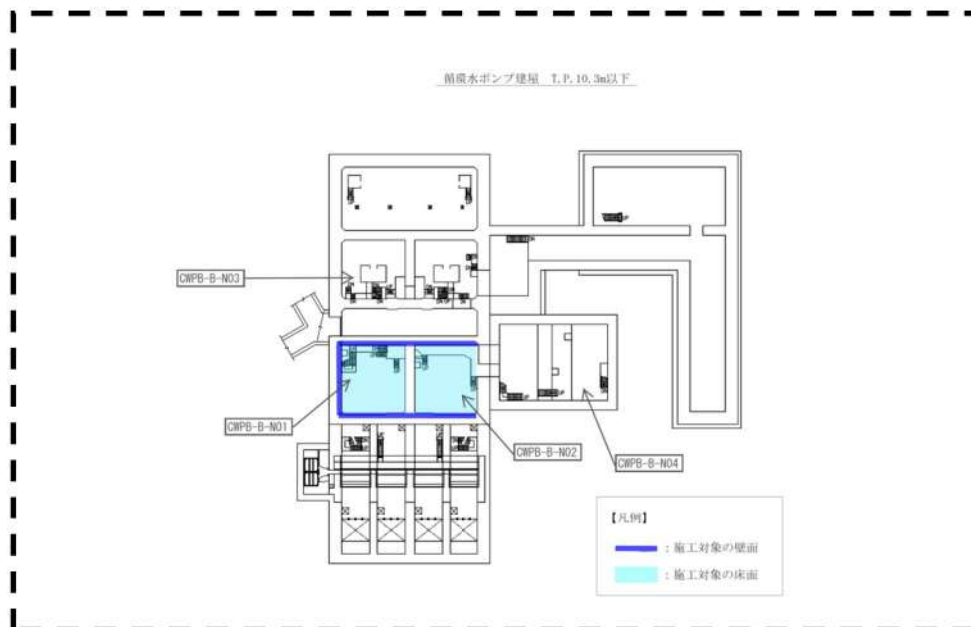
溢水防護対策施工対象の壁及び床の配置図 (11/11)
